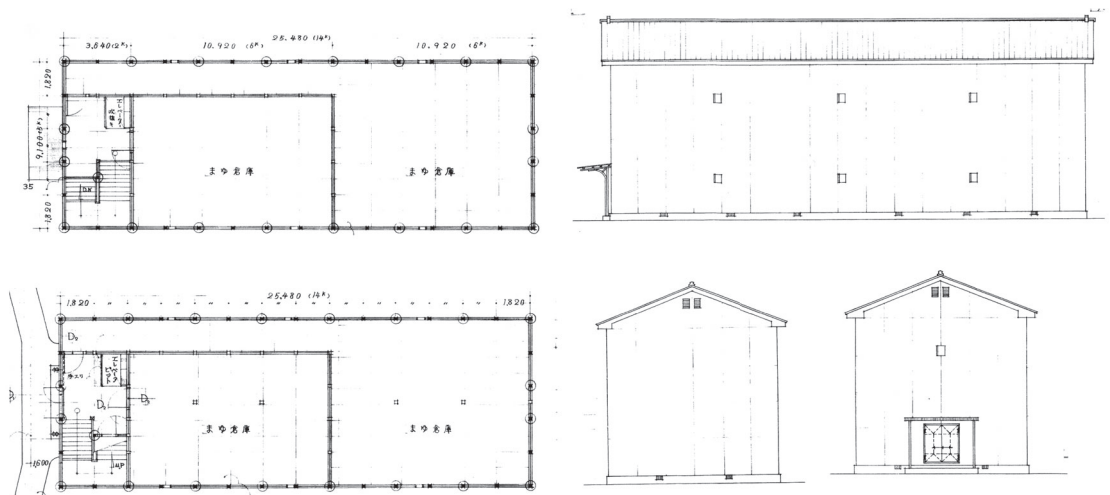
5号繭倉庫 各階平面図1階（下）・2階（上）、立面図北面（上）・西面（中）・東面（右） 1/400
